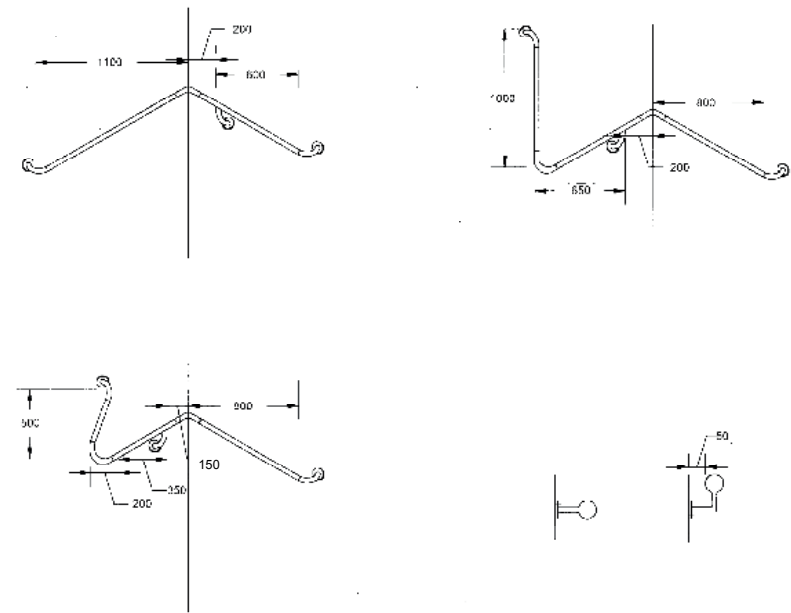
Barras de apoyo. Tipos. (Dimensiones en mm)
